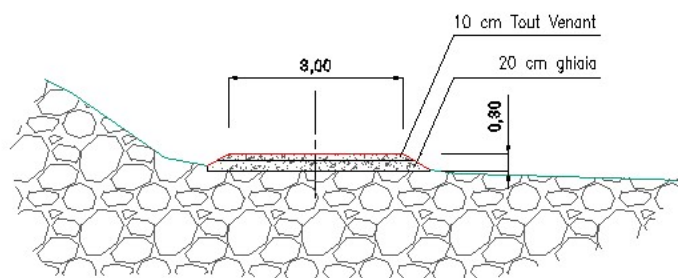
Sezione tipo della pista temporanea di progetto.
